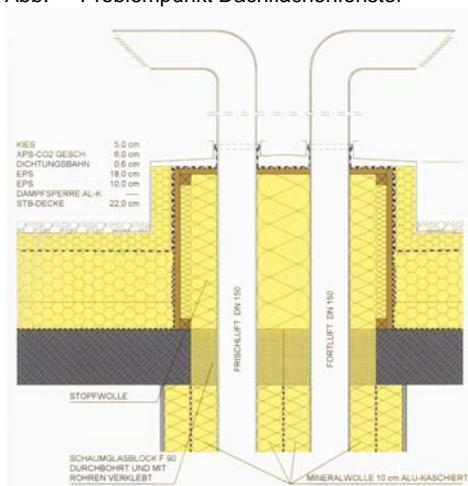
Problempunkt Dachdurchdringungen (Lüftung)
